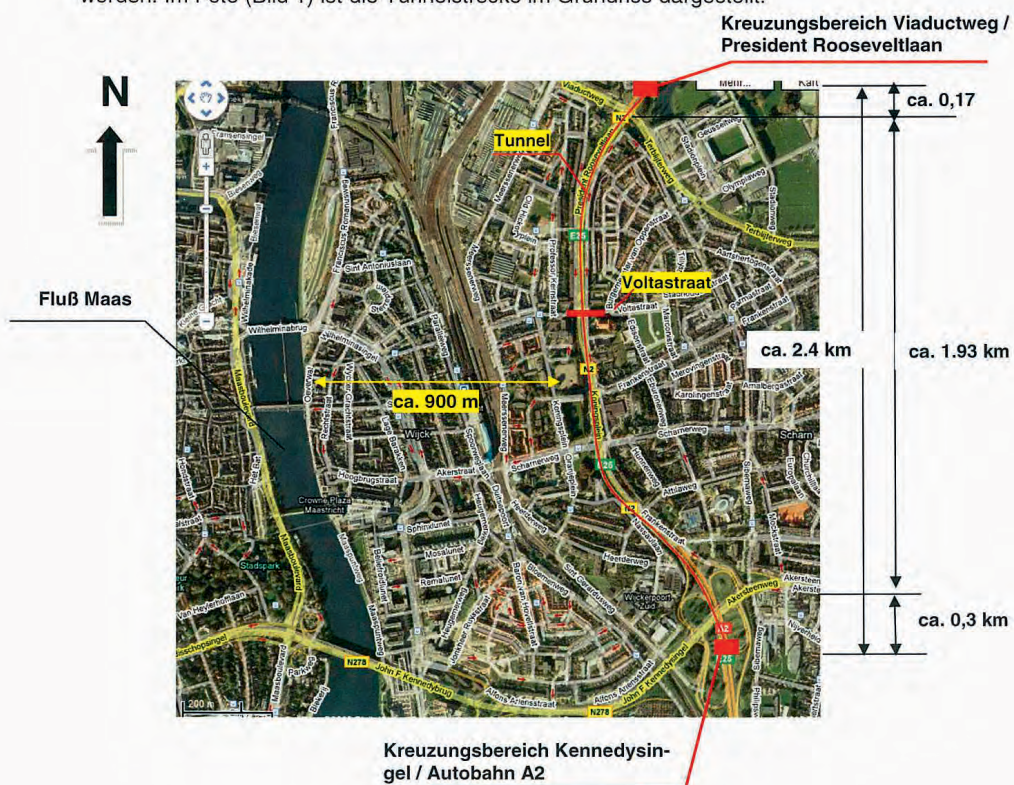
Lageplan der geplanten Tunnelstrecke vom Kreuzungsbereich Viaductweg / President Rooseveltlaan und dem Kreuzungsbereich Kennedysingel / Autobahn
